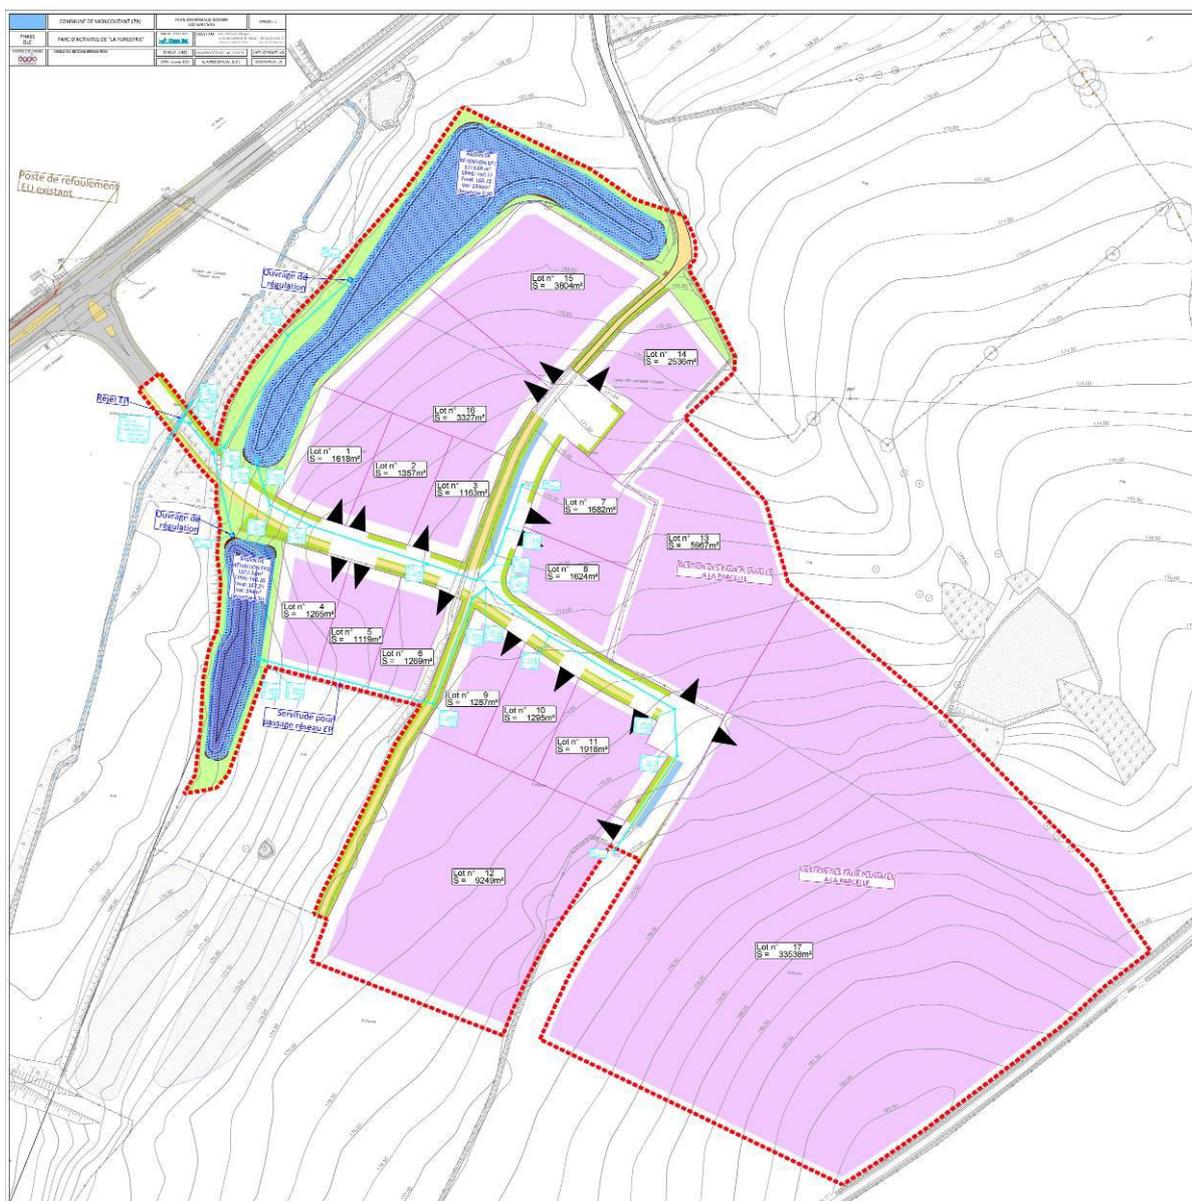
Implantation des ouvrages de tamponnement pluvial et réseau de collecte
